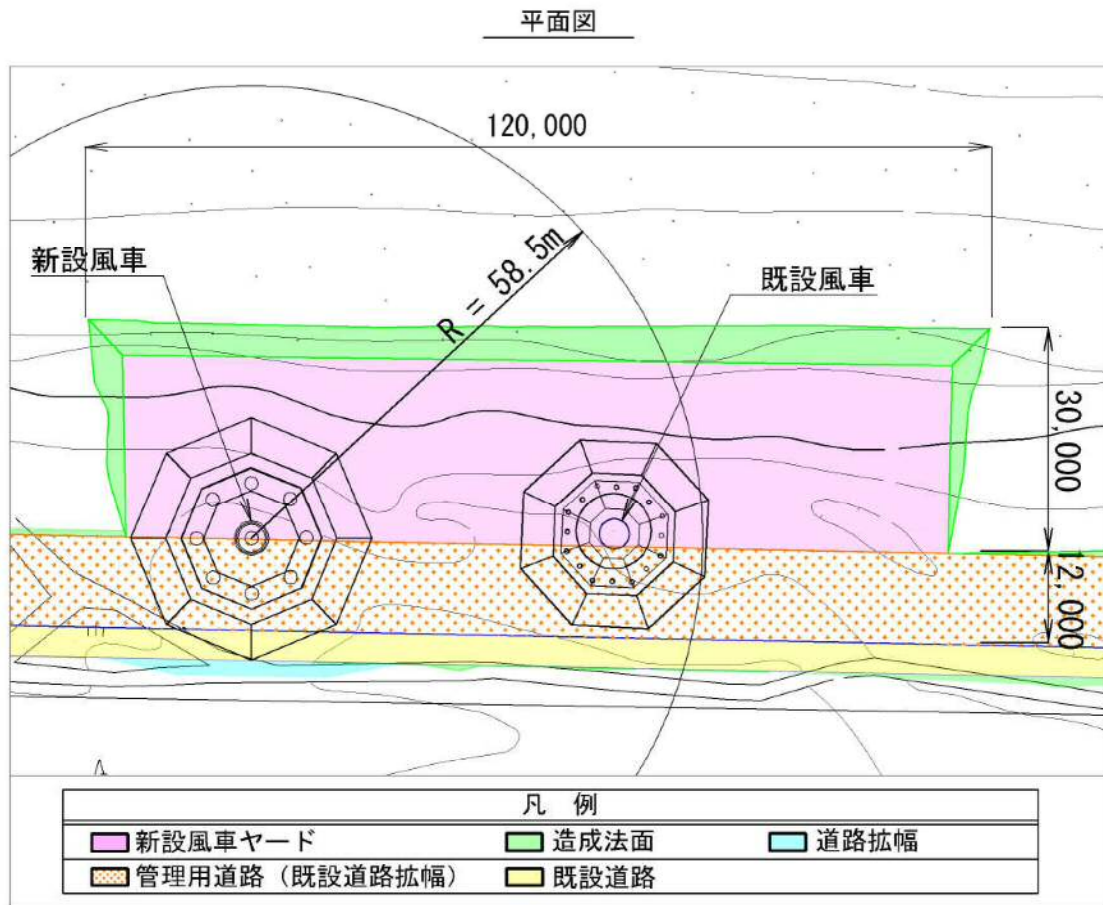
(3) 造成平面・横断計画図（新設3号機）
